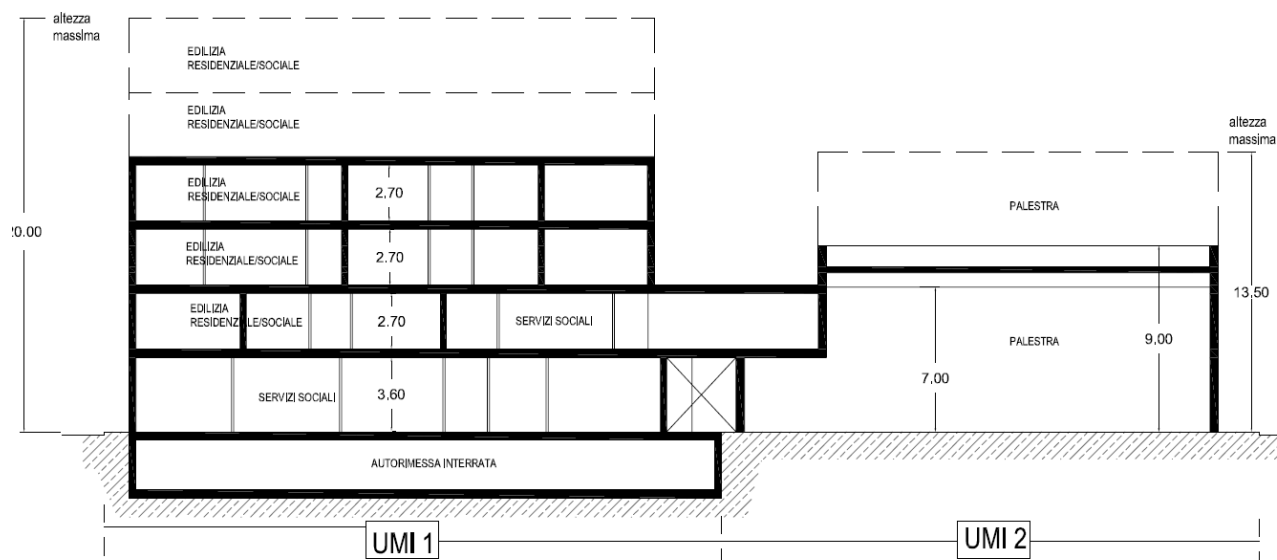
sezione tipo con individuazione delle UMI 1 e UMI 2
